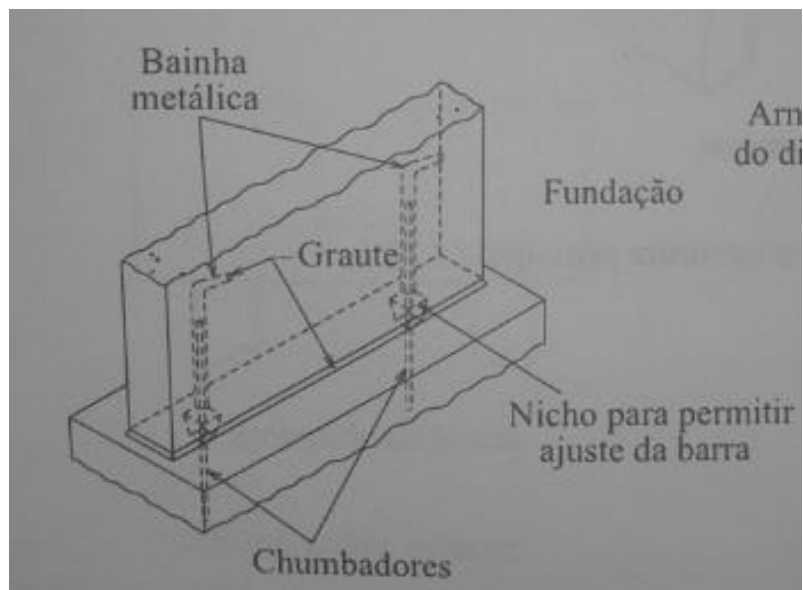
Ligação por meio de bainha metálica e chumbadores.
